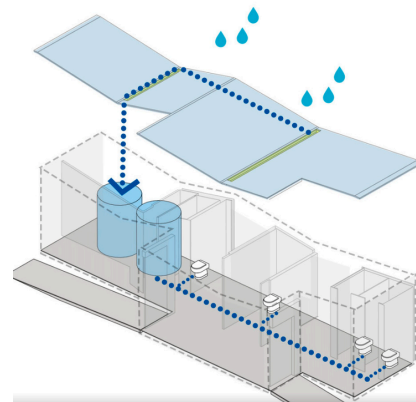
Sistema de captación pluvial proyecto "Flores 26"
